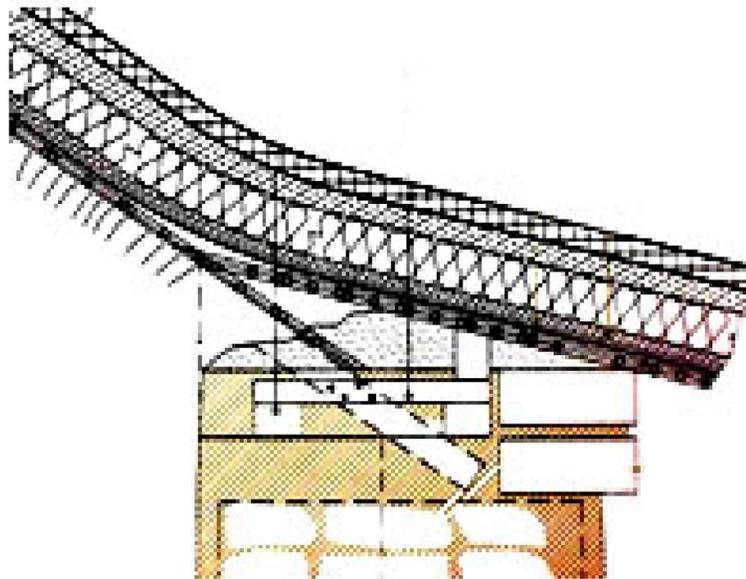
Detalle de instalación de escalerilla de madera como coronamiento de muros. Proyecto de restauración de la Iglesia de Mulluri, Chile. Fuente: Dirección de Arquitectura MOP en Archivo del Consejo de Monumentos Nacionales, Chile.
